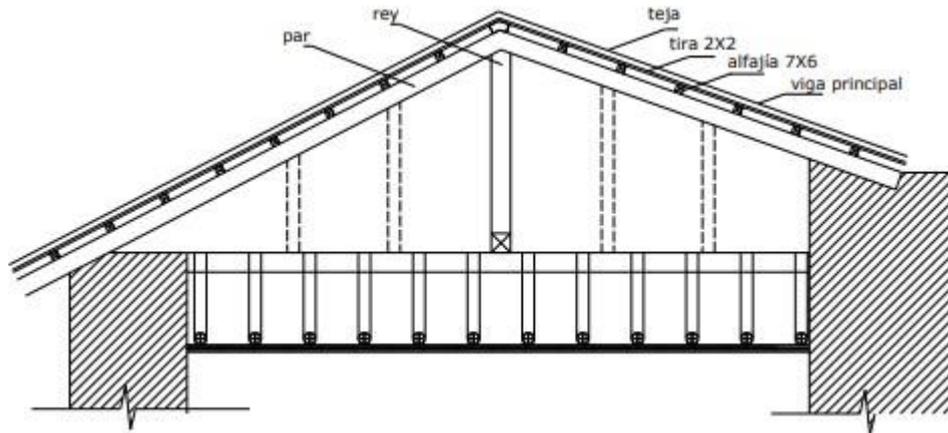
Estructura de madera de cubierta existente, sistema de par y rey
